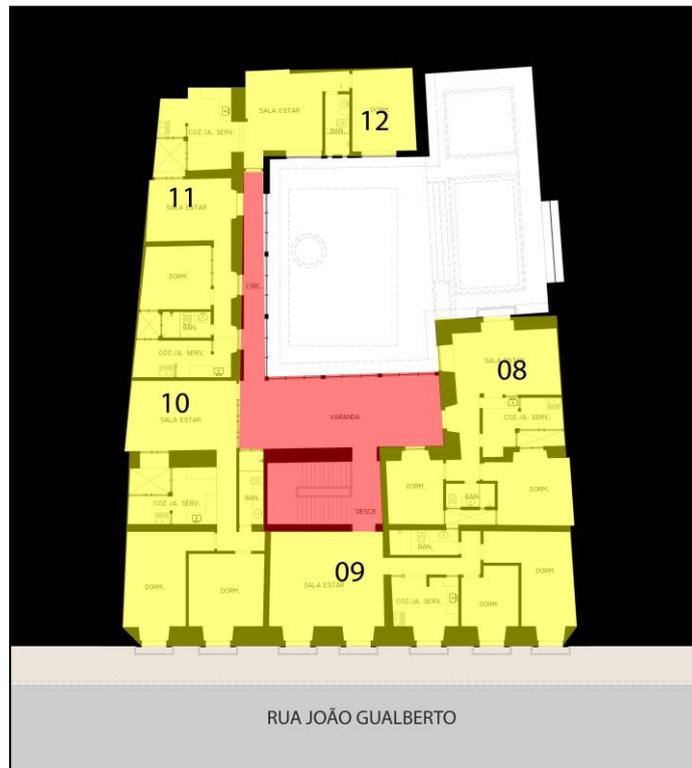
Planta-baixa do 1º pav. do imóvel da Rua João Gualberto, 49.
